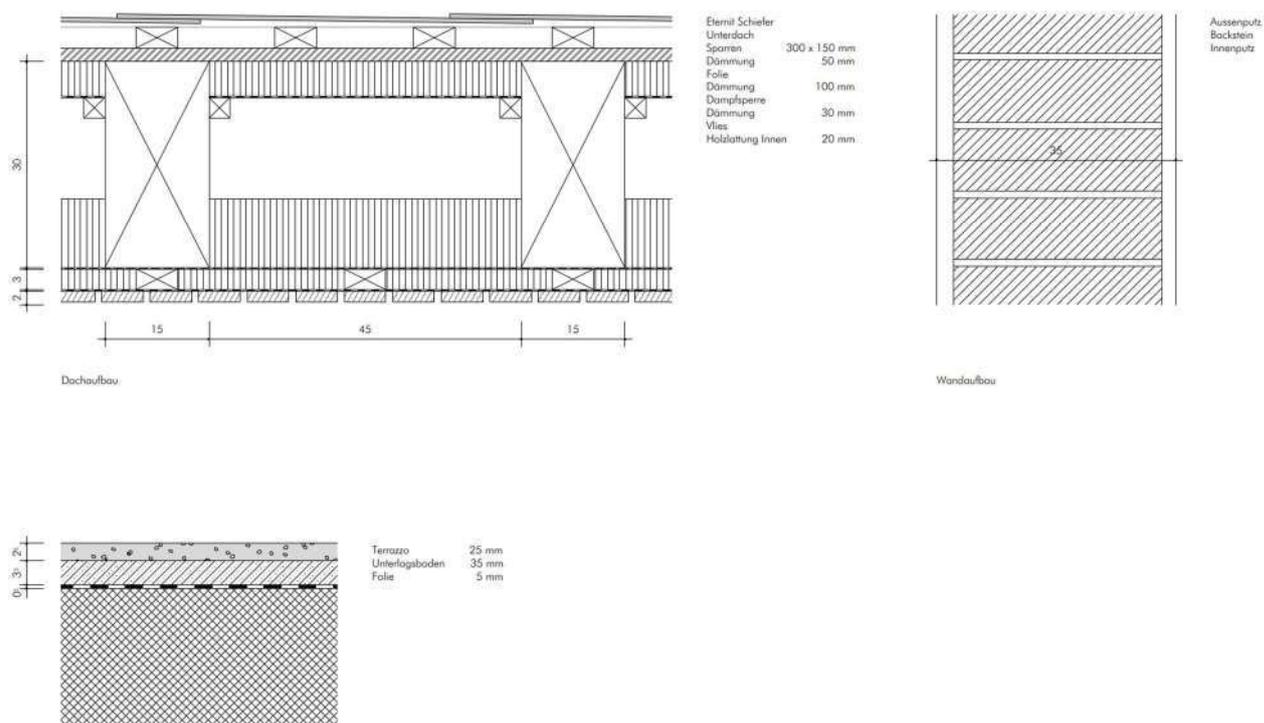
Bestand: Dachebene, Mauerwerk, Deckenaufbau
